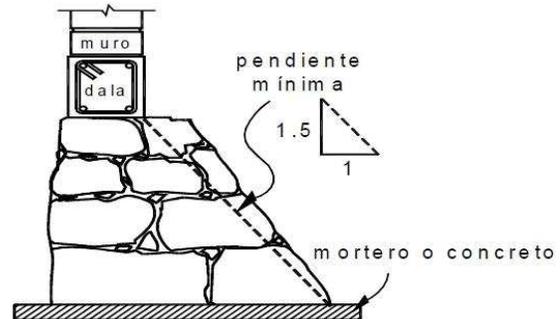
Pendiente en escarpios de mampostería de piedra (NTCDCEM2004)
